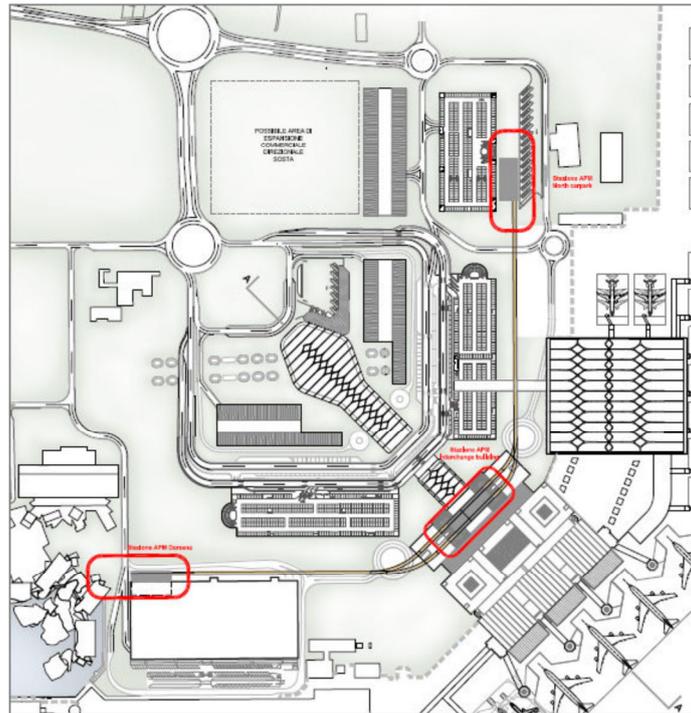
Programma degli interventi – Piano decennale 2012-2021. Estratto; Planimetria schematica del sistema People Mover
